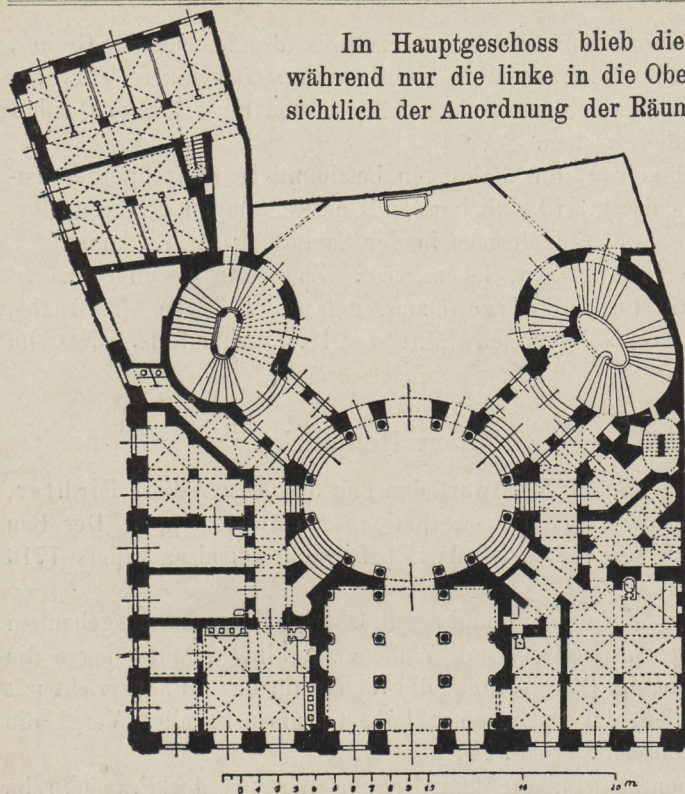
Schönburg'sches Palais, Grundriss des Erdgeschosses.
